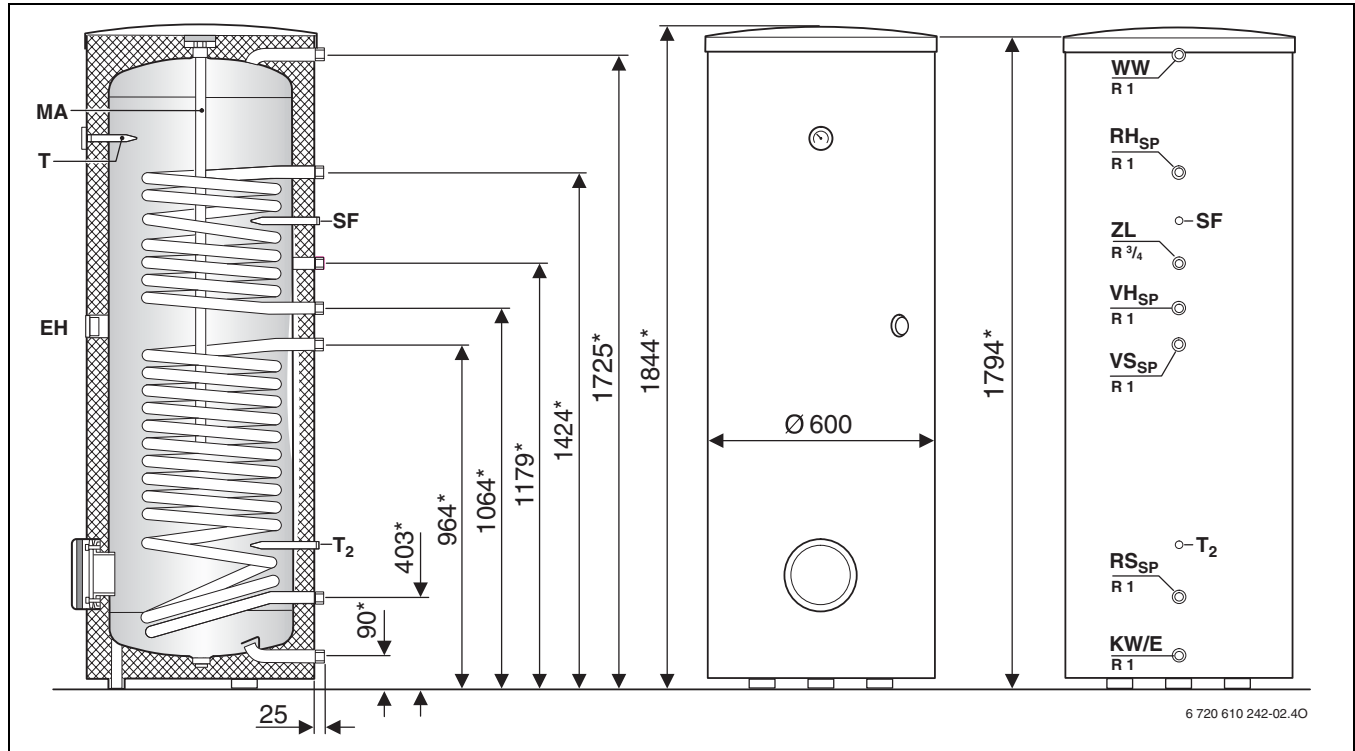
Bau- und Anschlussmaße SK 300-1 solar
